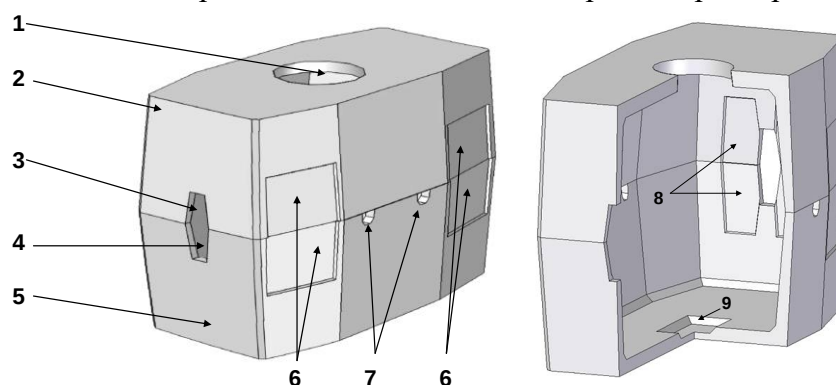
Колодец «ККСр-4-10», внешний вид и детали элементов колодца:
